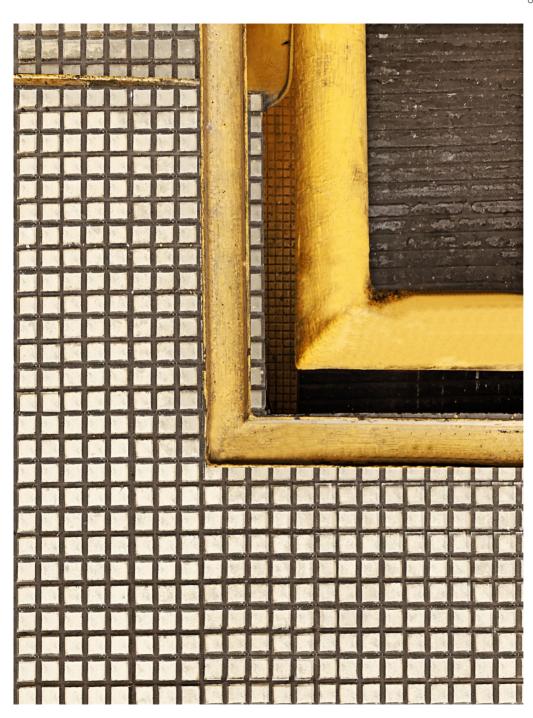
detalle piso y baranda (2016) Fuente: muro\_arquitectos (2016) Digitalización: Tocto, J. (2016)
